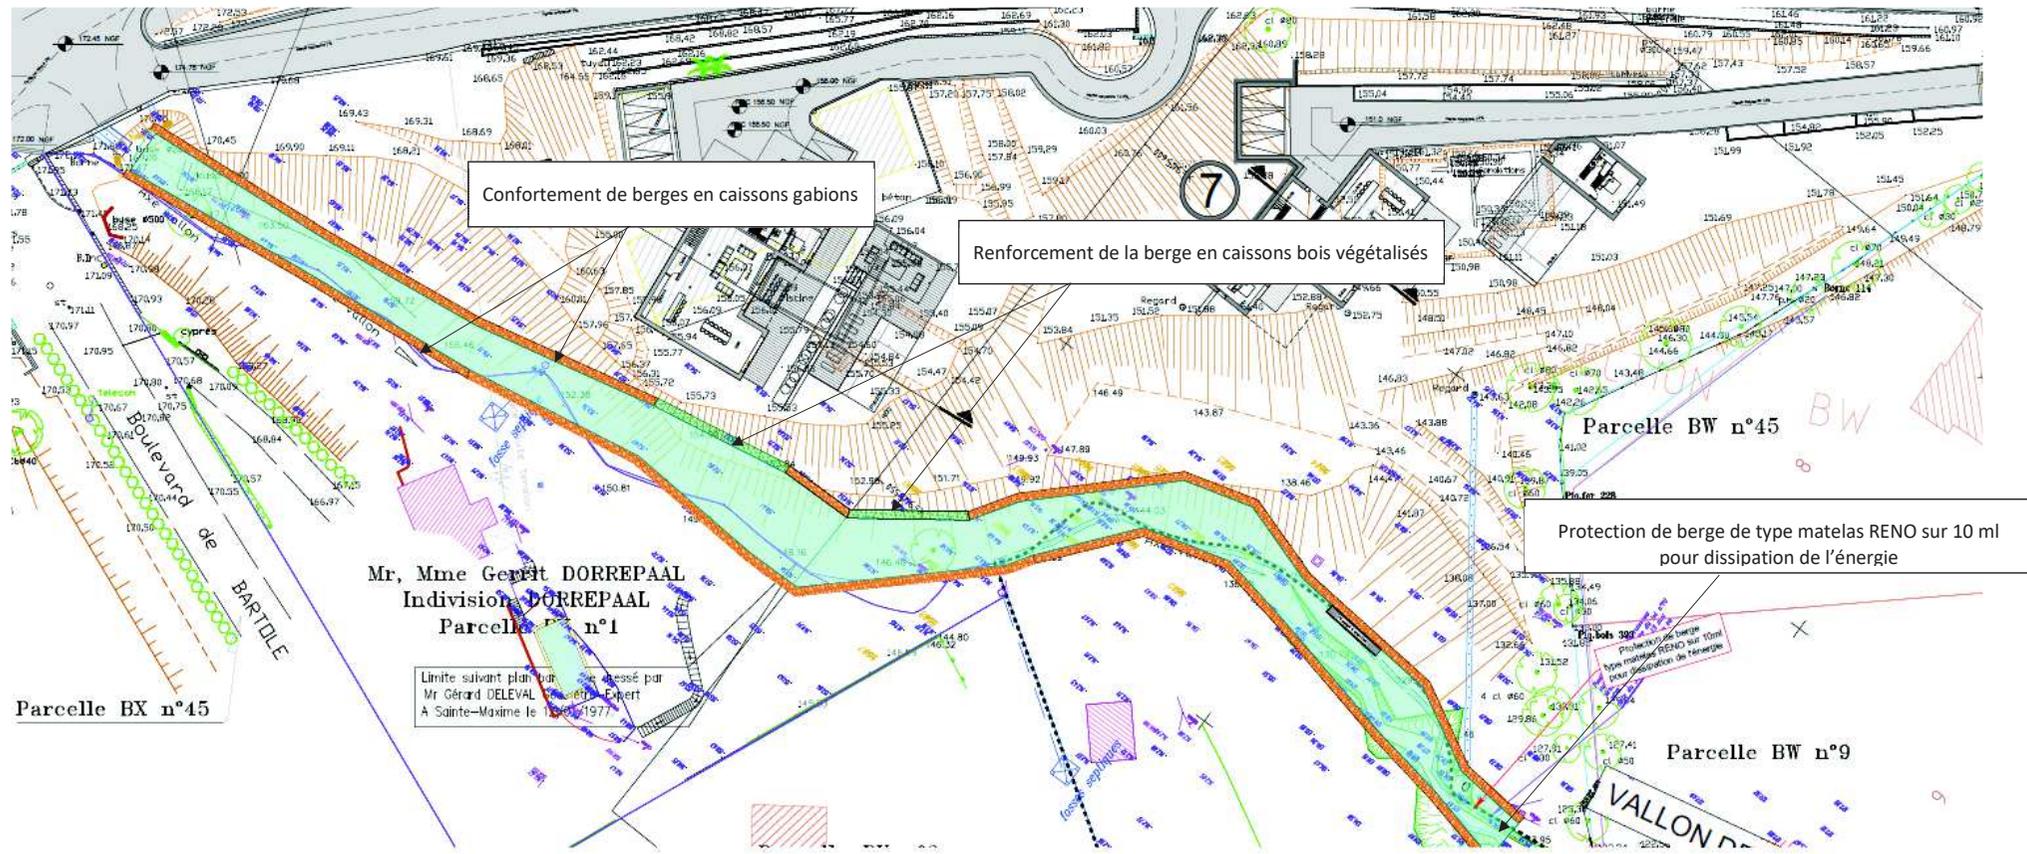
Aménagements proposés sur la Suane au droit de la zone du projet
